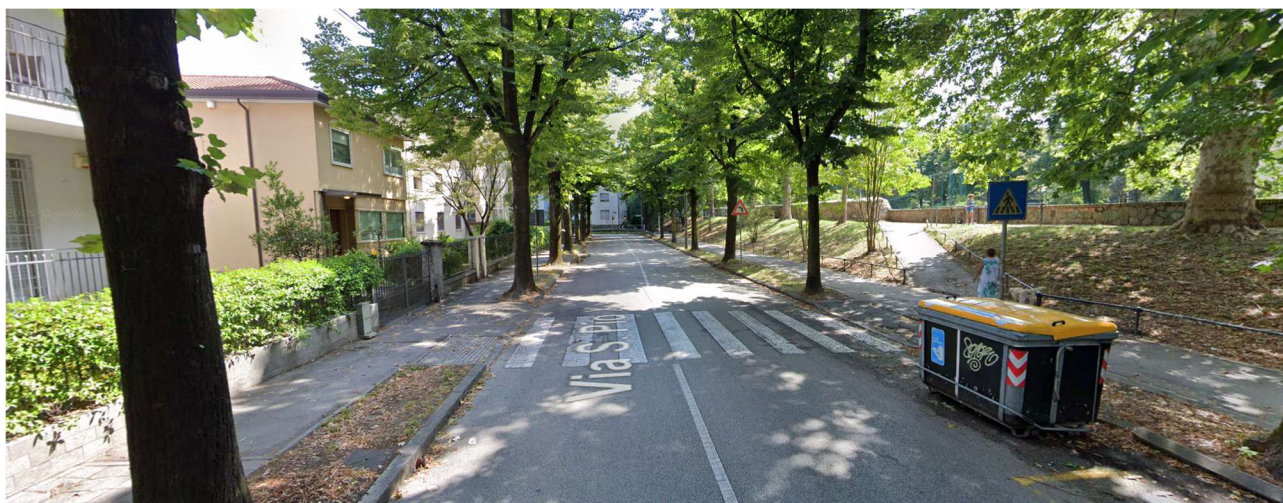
Via S. Pio X L'attraversamento pedonale oggetto dell'intervento
